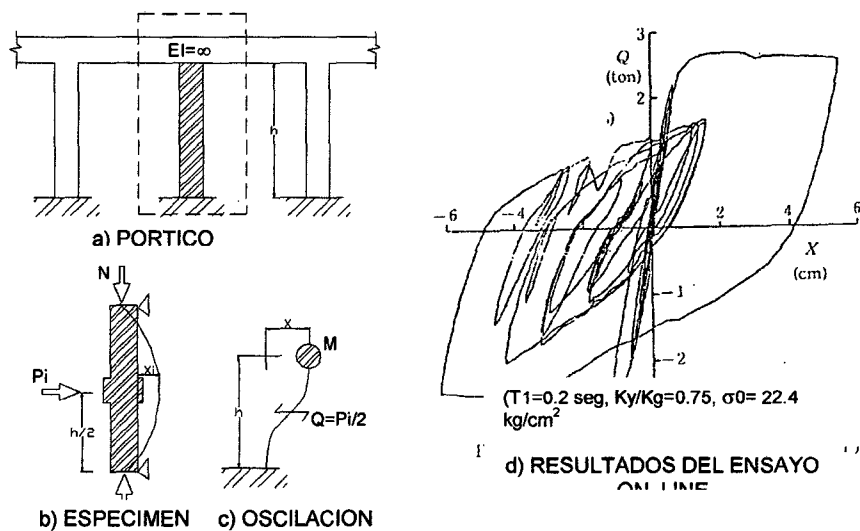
Montaje Del Especimen Para El Ensayo On-Line En Un Pórtico De Concreto Reforzado.(Ref.3:pag.13)
